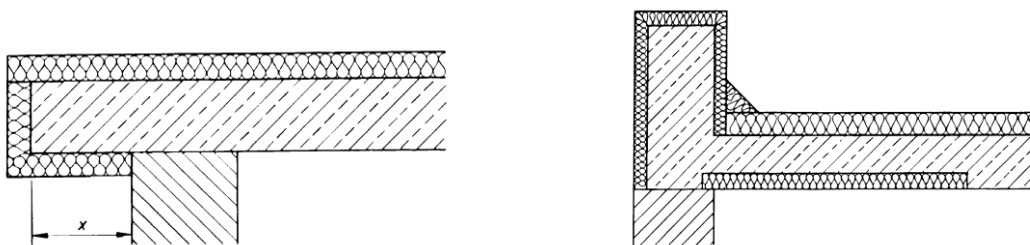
Außendämmung einer überstehenden Betonplatte und einer Attika eines Flachdaches
